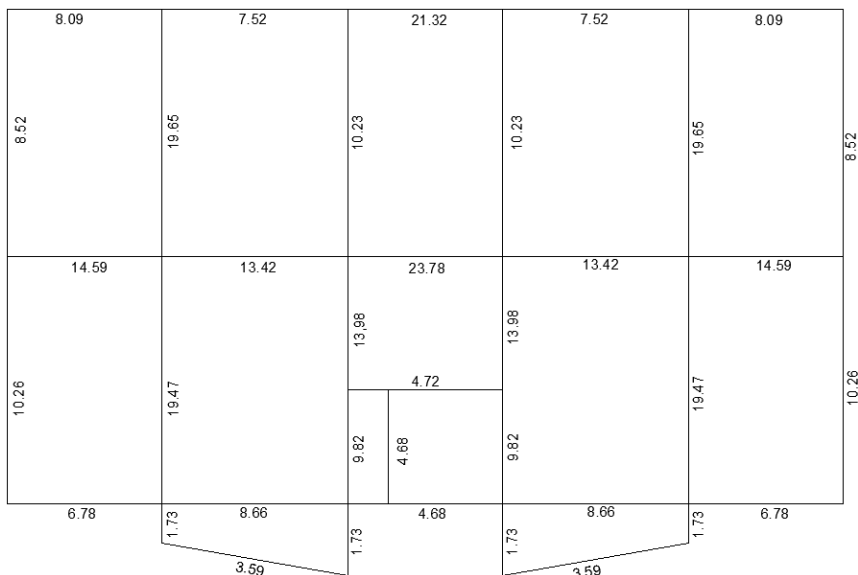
Carregamentos de alvenaria e reações das lajes no pavimento tipo em kN/m com valores característicos do exemplo 1 (Desenvolvido pelo autor)
